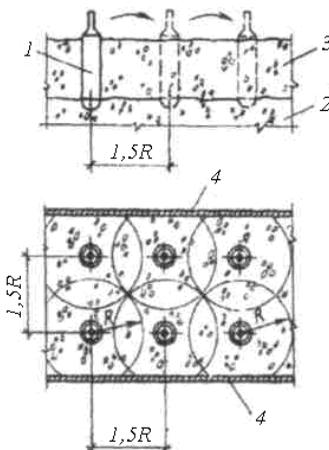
Виброуплотнение бетонной смеси: 1 – рабочий орган вибратора; 2 – ранее уложенный слой бетона; 3 – укладываемый слой; 4 – опалубка
